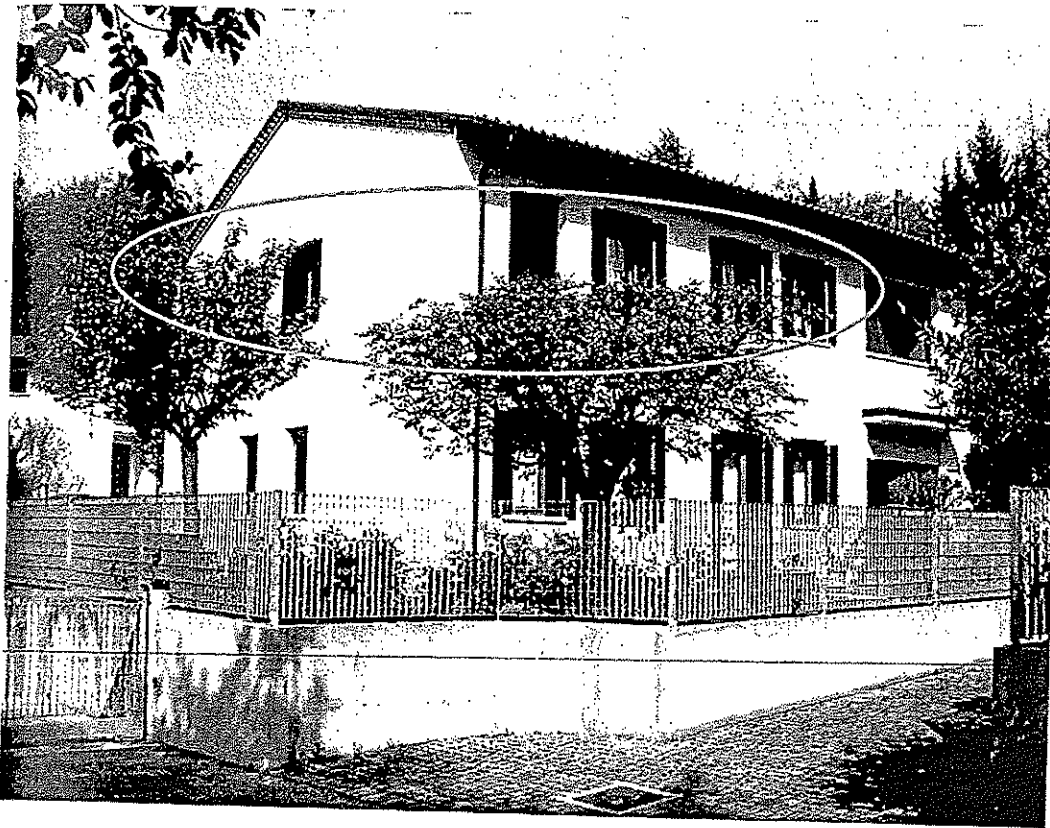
Vista da sud-est del residence comprendente i beni oggetto di pignoramento. L'appartamento di cui al M.N. 1098 sub 32 è al piano primo.
